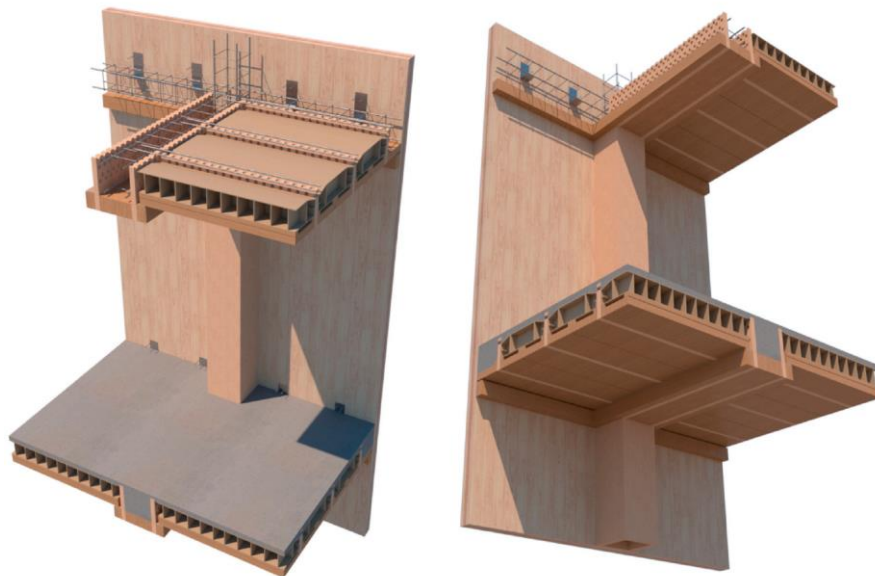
Vue générée du système complet de plancher mixte bois-béton combiné avec un panneau CLT [11].
